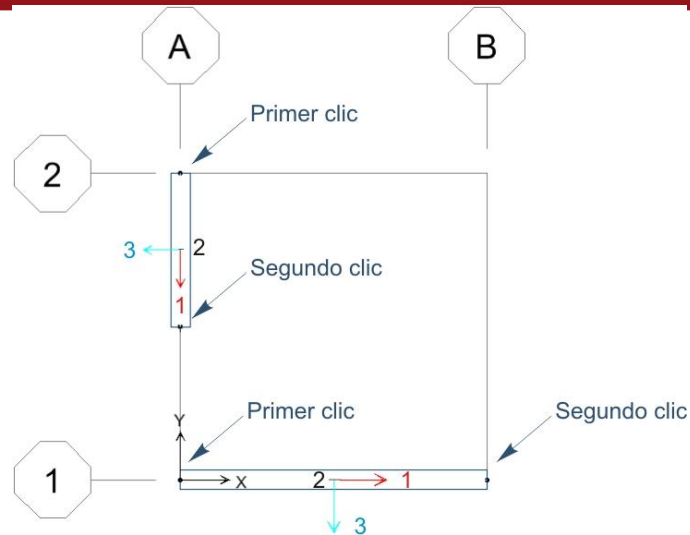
Ejes locales de muros creados en una vista en planta.
